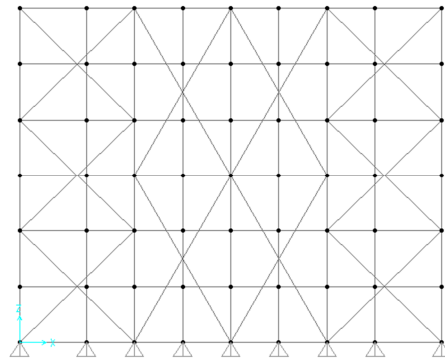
Configuração dos Planos de Contraventamento Vertical Com Elementos de Contraventamento Grandes
